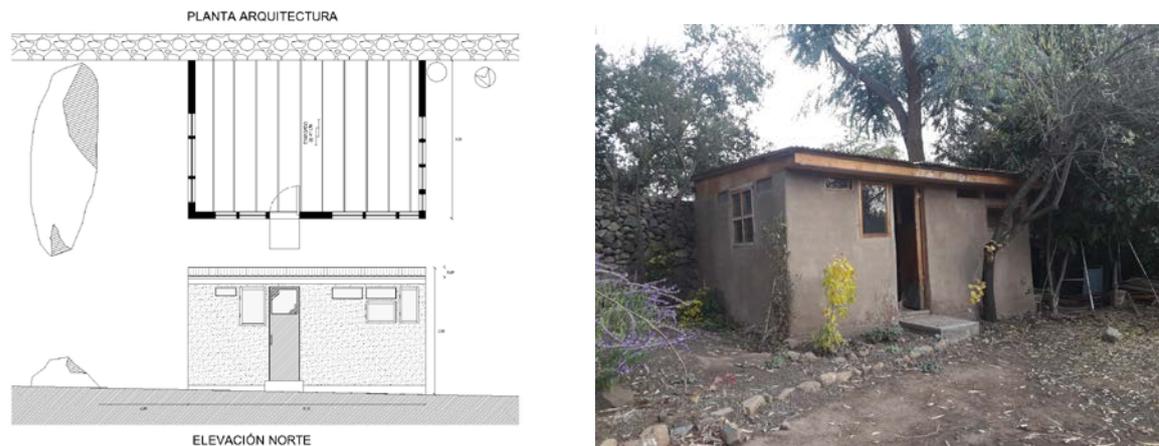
Planos de levantamiento y vista de la bodega en situación inicial.
